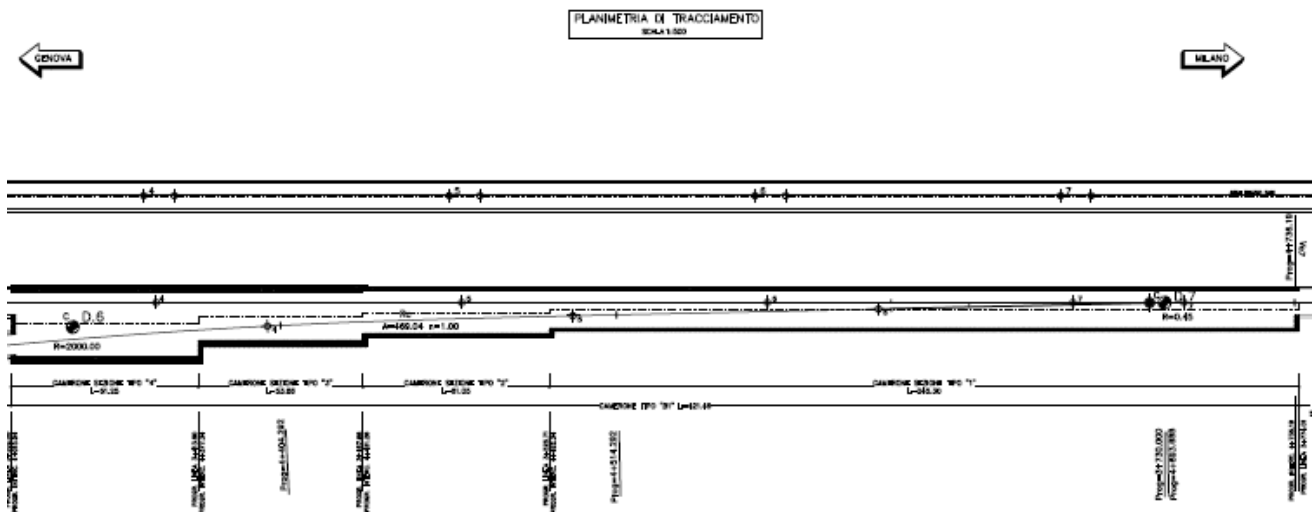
Sezioni tipo camerone previste da Progetto Definitivo
